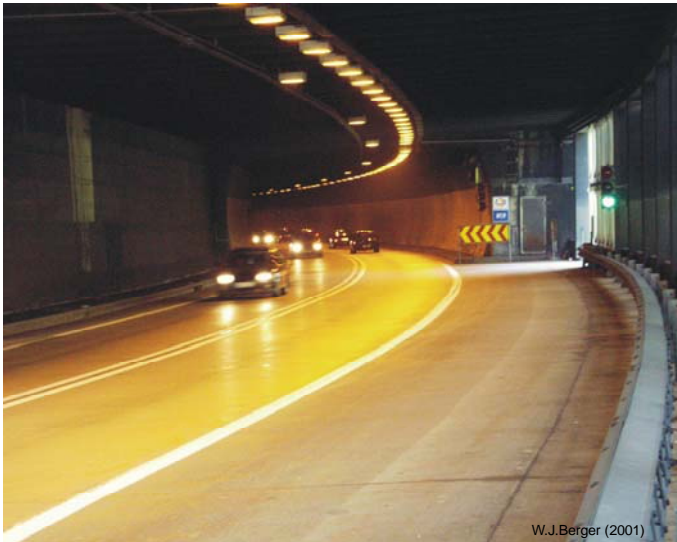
Katschbergtunnel: Länge 5.400 m; einröhrig mit Gegenverkehr (Vollausbau in Vorbereitung)
